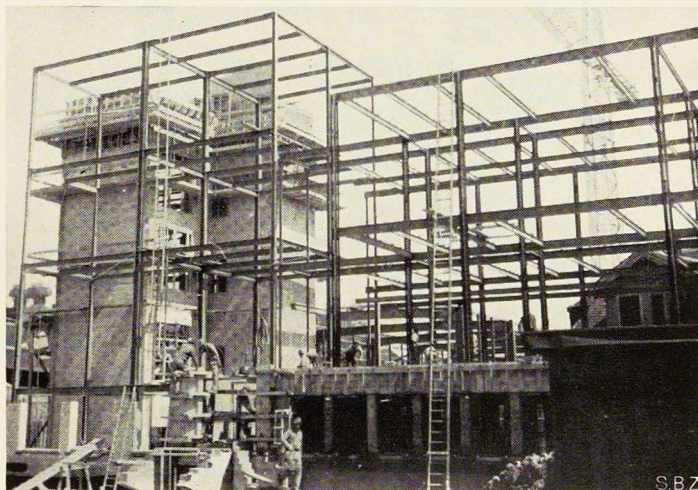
Laboratoire et bâtiment d'essais en cours de montage.
